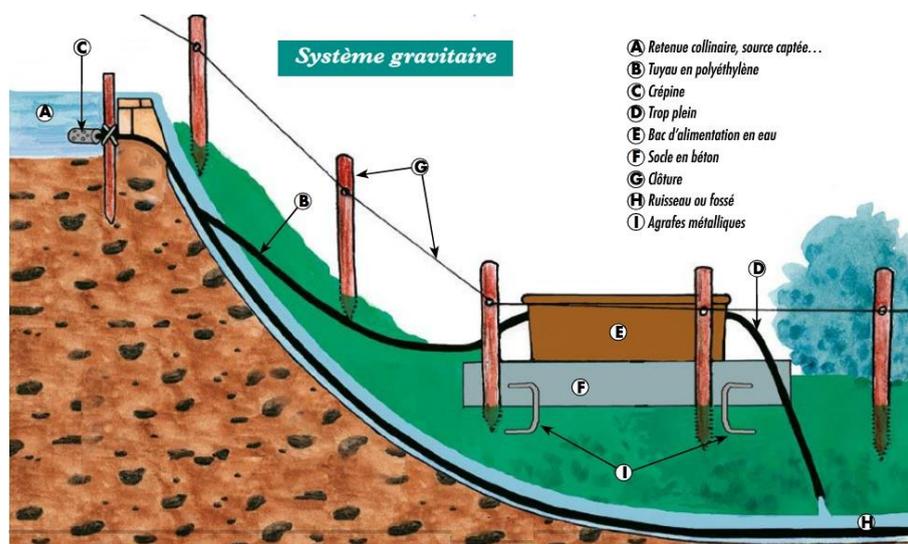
Principe de construction d'un système gravitaire pour l'abreuvement du bétail
